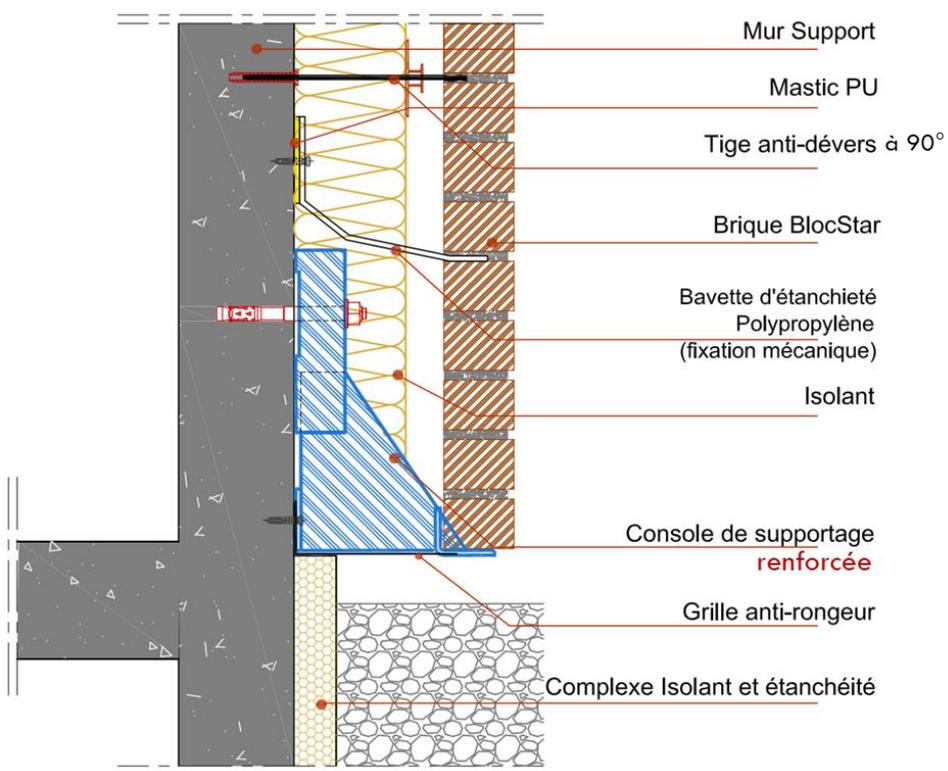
Appui du 1er rang sur console de supportage renforcée (1 seul niveau)
